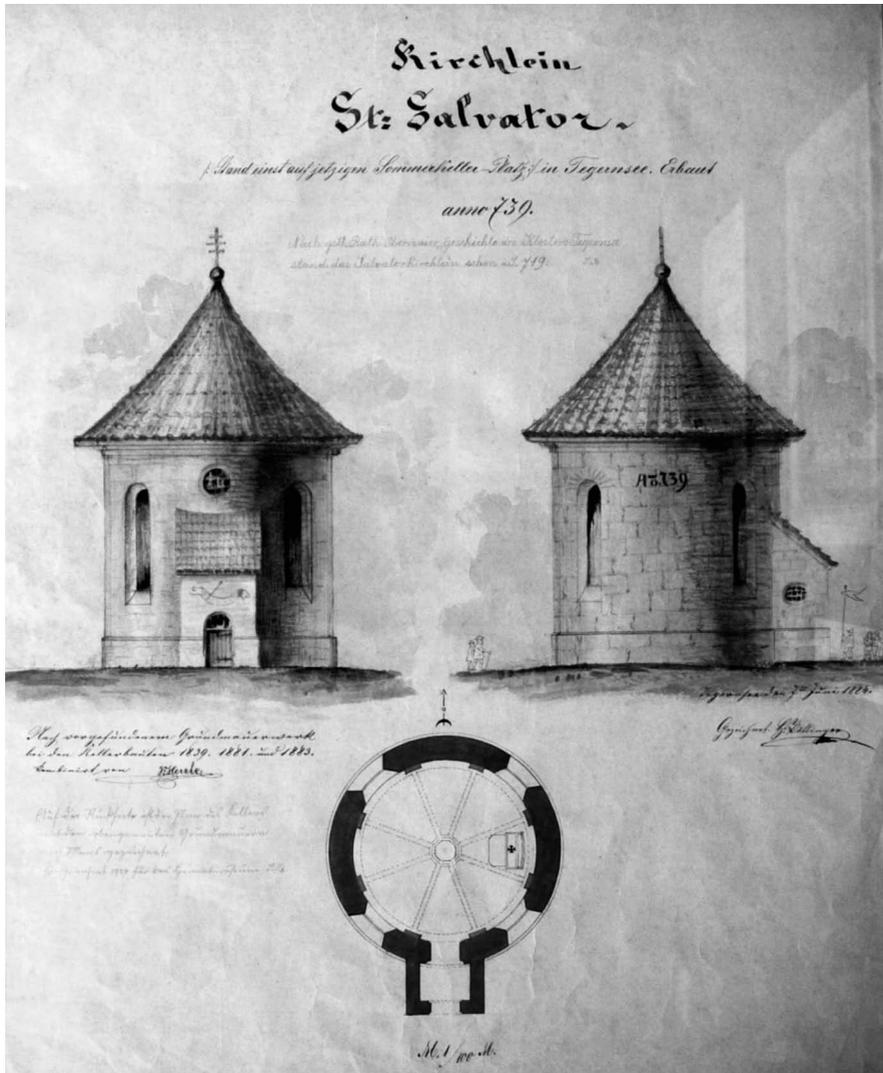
Tegernsee, Lkr. Miesbach. Darstellung des Grundrisses und Rekonstruktionsversuch des Aufgehenden der Salvatorrotunde. Der vom Tegernseer Zeichenlehrer Hans Pöttinger erstellte Plan ist datiert vom 7. Juni 1884 und im Museum Tegernseer Tal hinter Glas ausgestellt (Foto Museum Tegernsee; Inv.-Nr. 138, Leihgabe der Fam. Stadler-Saliterer).
